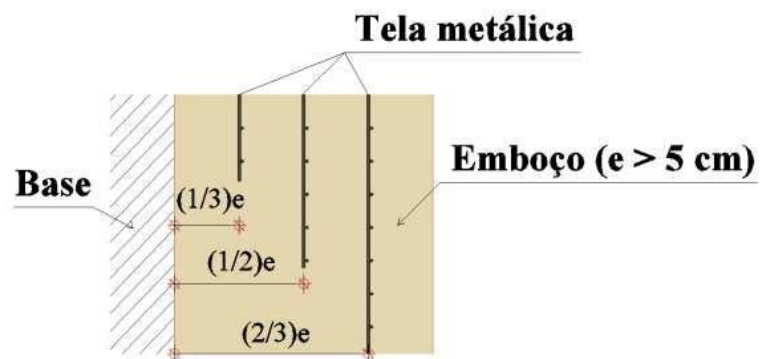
Posicionamento centralizado das telas no encontro de alvenaria e estrutura
